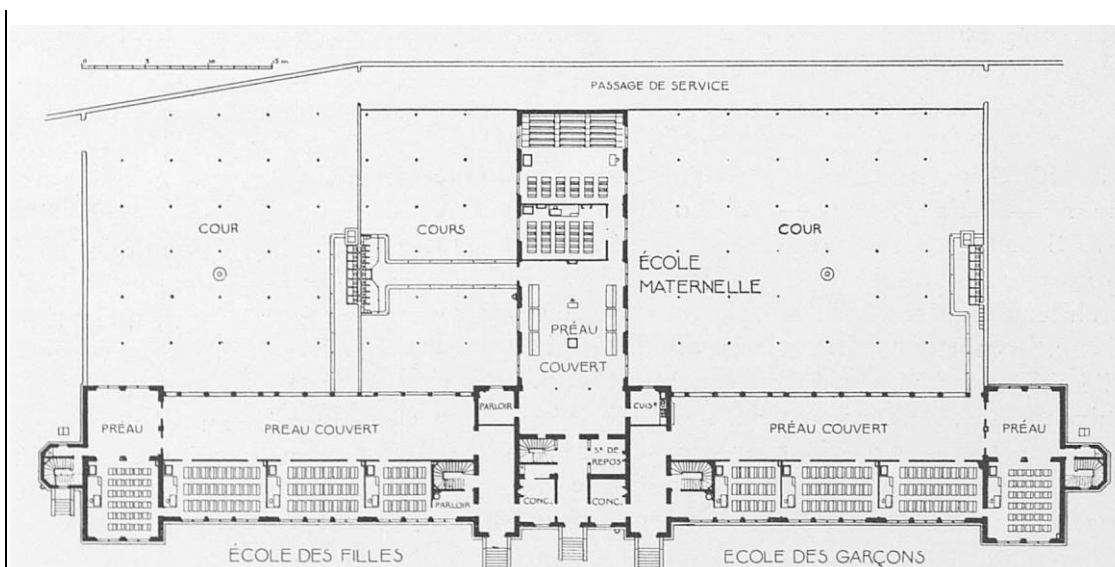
Gustave-Laurent Raulin, architecte. Plan du rez-de-chaussée du groupe scolaire de la gare à Ivry-sur-Seine (1879-1880). In *L'architecte*, décembre 1910, n°12, p. 98.
